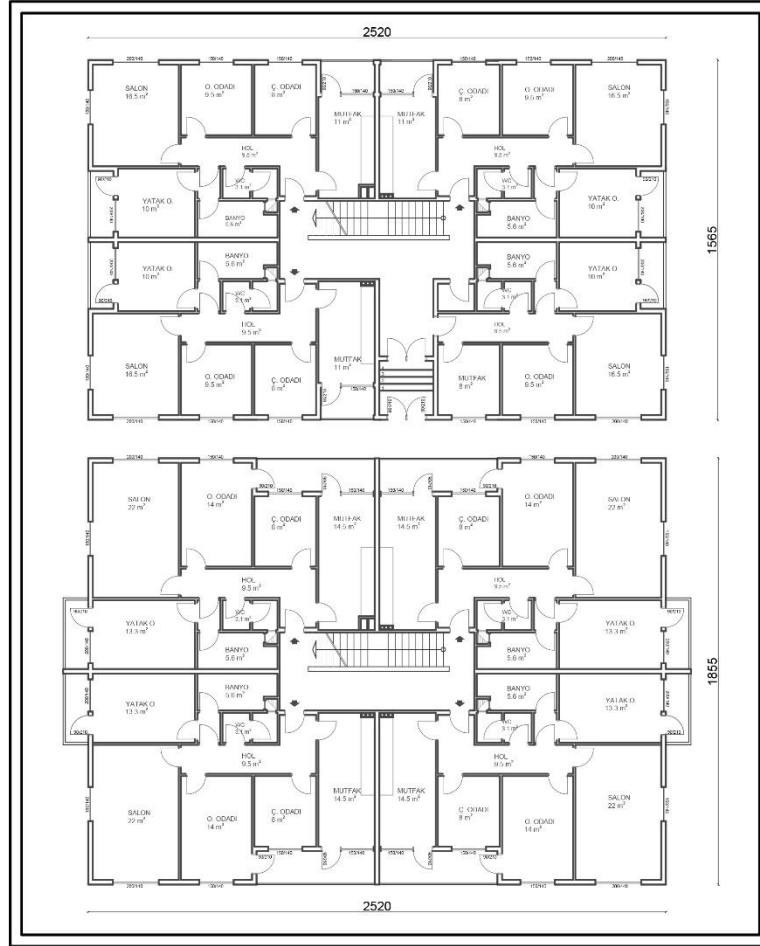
'de kat planı verilen 2004 yılına ait bina 4 katlıdır. Zemin alanı 210 m²'dir. Betonarme olarak yapılan ev 2604 m³ dür. Yapının zemin katında kapalı otopark bulunmaktadır. Yapıda her katta 2 daire bulunmaktadır. Dairelerde mutfak, 4 adet oda, banyo, wc ve 3 adet balkon bulunmaktadır. Balkon kapıları ve pencerelerde iki odacıklı PVC camlar kullanılmıştır. Cephelerdeki pencere ve kapı oranı %22'dir. 2004 senesinde yapılan bu ev iki tuğla arası 5 cm'lik Ekspande polistren köpük (EPS) kullanılmıştır. Kullanılmayan çatı arasında ise 5 cm'lik cam yünü kullanılmıştır. Isıtılmayan iç ortama bitişik zemin döşemesinde ise 5 cm'lik Ekspande polistren köpük (EPS) kullanılmıştır. 2004 yılına ait binanın görünüşleri EK-5'de sunulmuştur.
